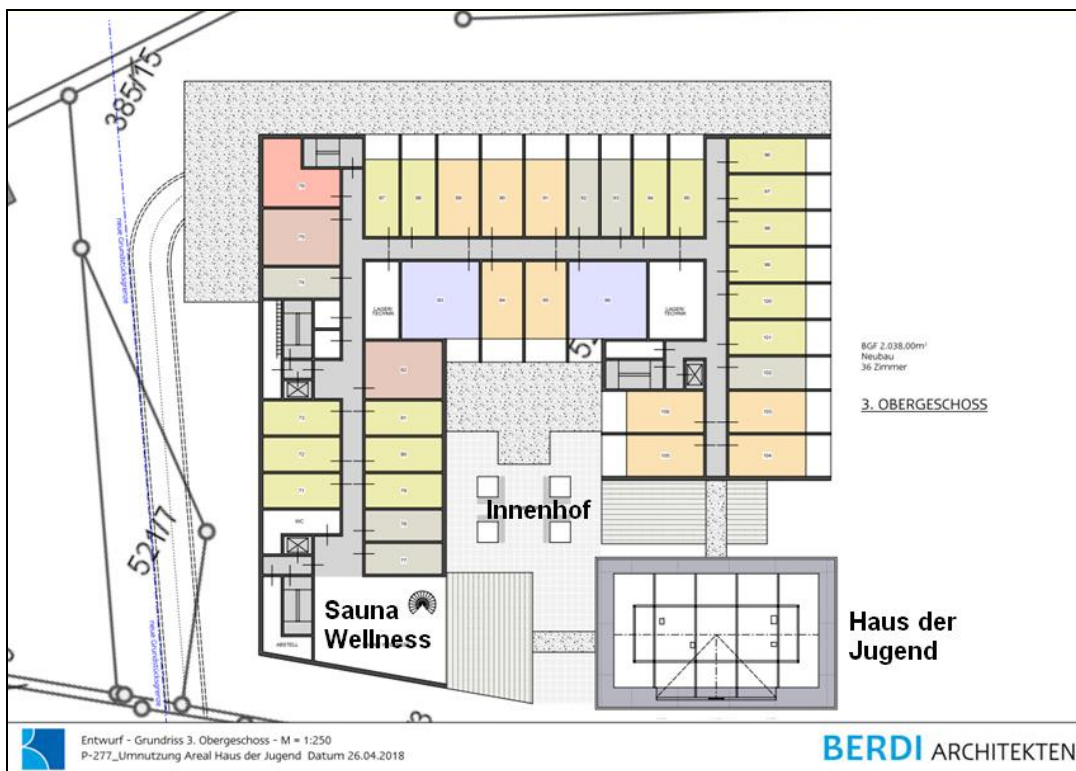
Grundriss 3. Obergeschoss (Hotelzimmer/Sauna/Wellness)
